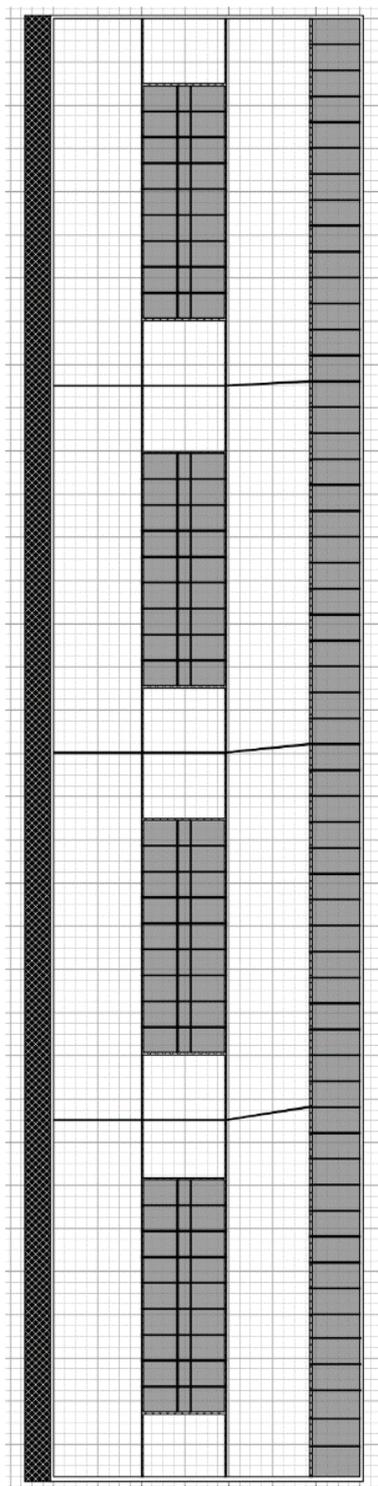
Plan für Strohalle als Boxenlaufstall (eigene Darstellung)
